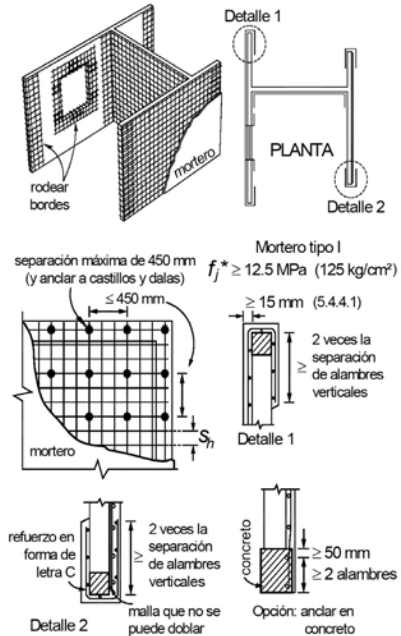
MALLAS DE ALAMBRE SOLDADO
